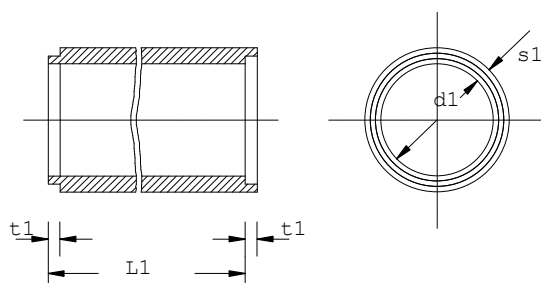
tubi in calcestruzzo di sezione circolare con giunto a risega senza piede
